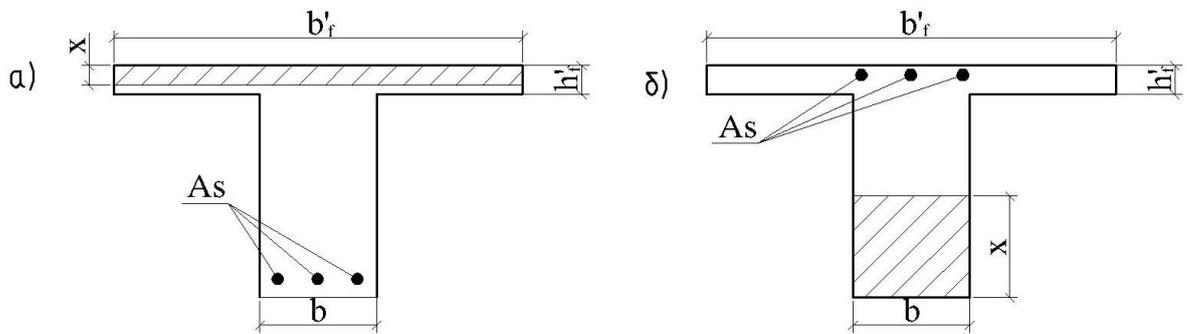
Расчетные поперечные сечения второстепенной балки. а) в пролете, б) на опоре
